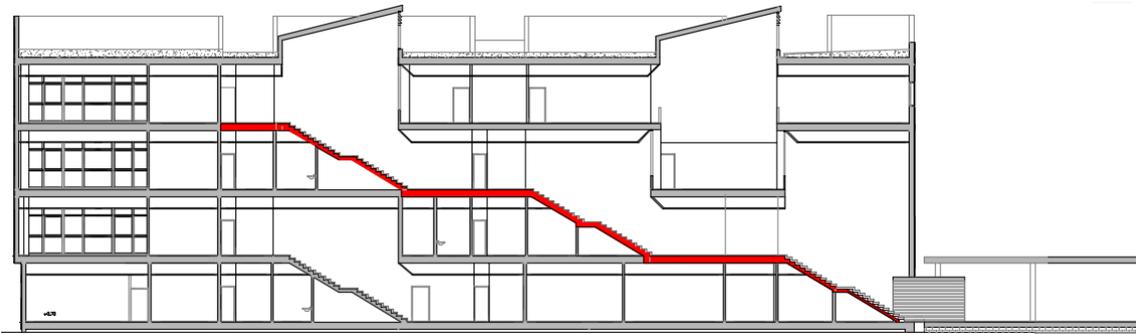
Situación escalera principal edificio. Figura extraída del plano 32.
